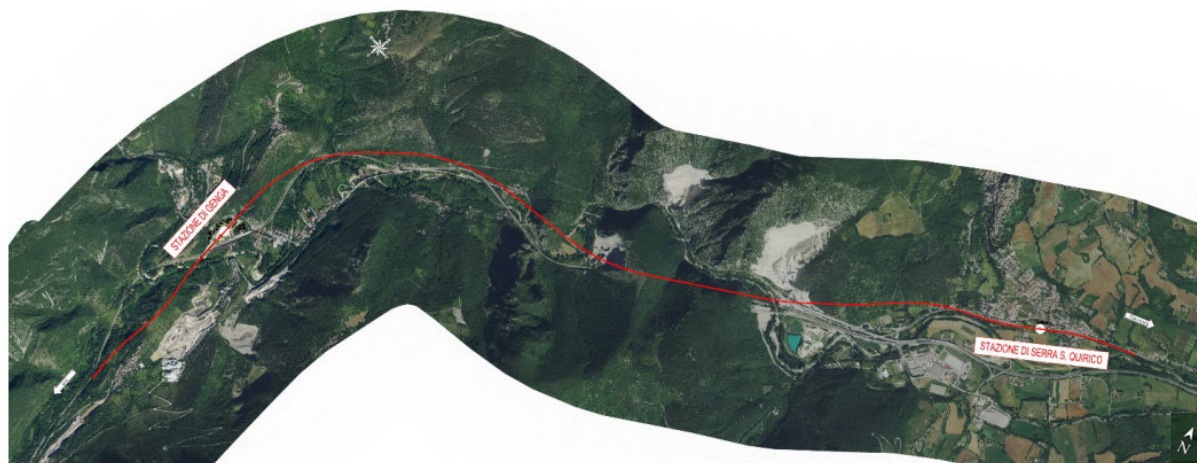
Inquadramento tracciato di Progetto Lotto 2, ortofoto
